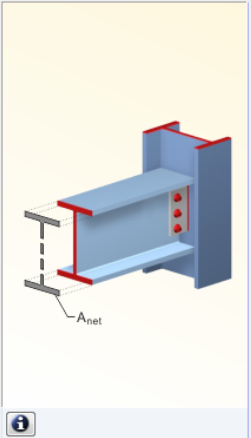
Querschnittsfläche für Zugnachweis definieren
